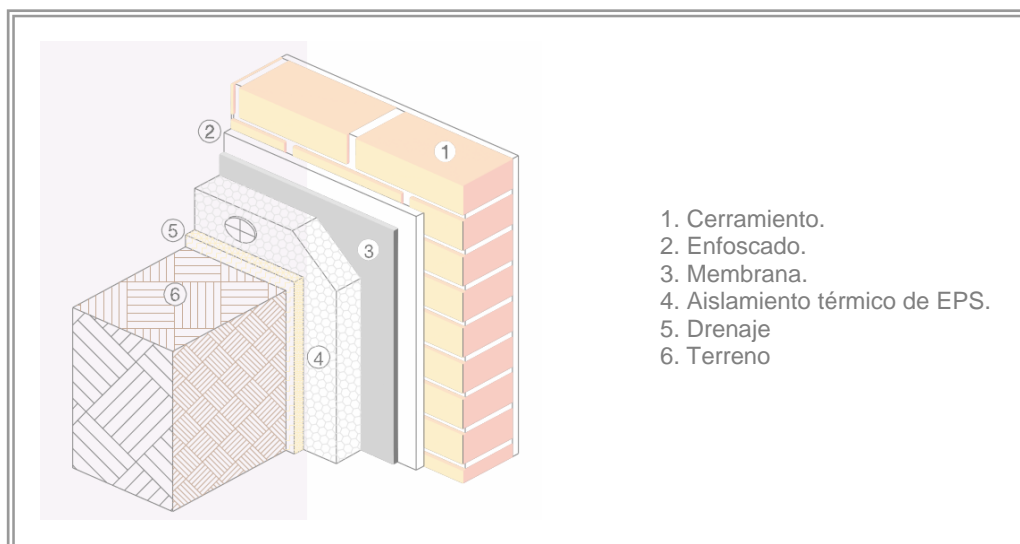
Solución esquemática de aislamiento de un muro de sótano. (ANAPE)
